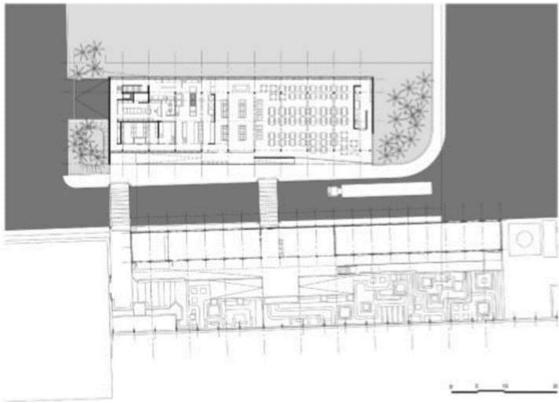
Planta baixa do restaurante. Fonte: Arcoweb, 2008.
